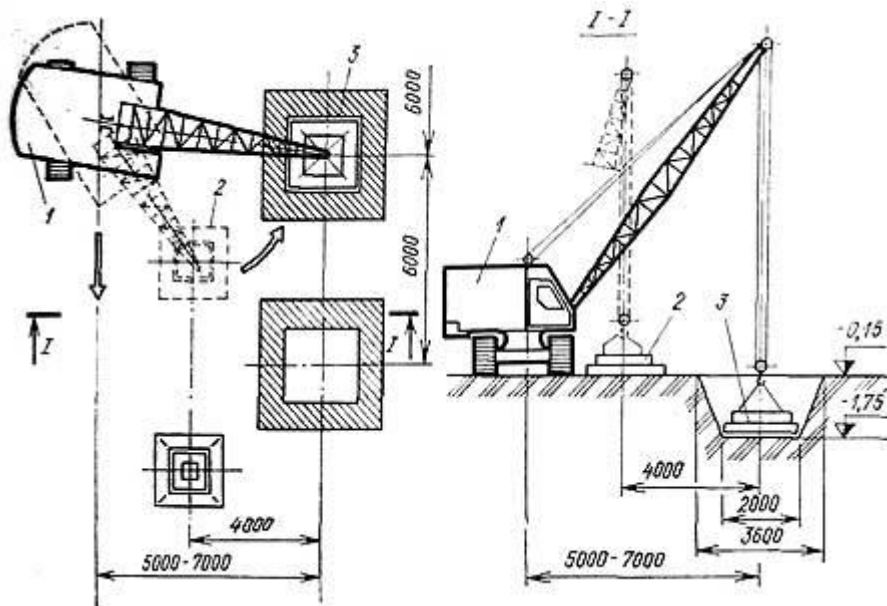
Монтаж фундаментов: 1 — гусеничный кран; 2 — положение блоков фундаментов до подъема; 3 — блок фундамента на проектной отметке
